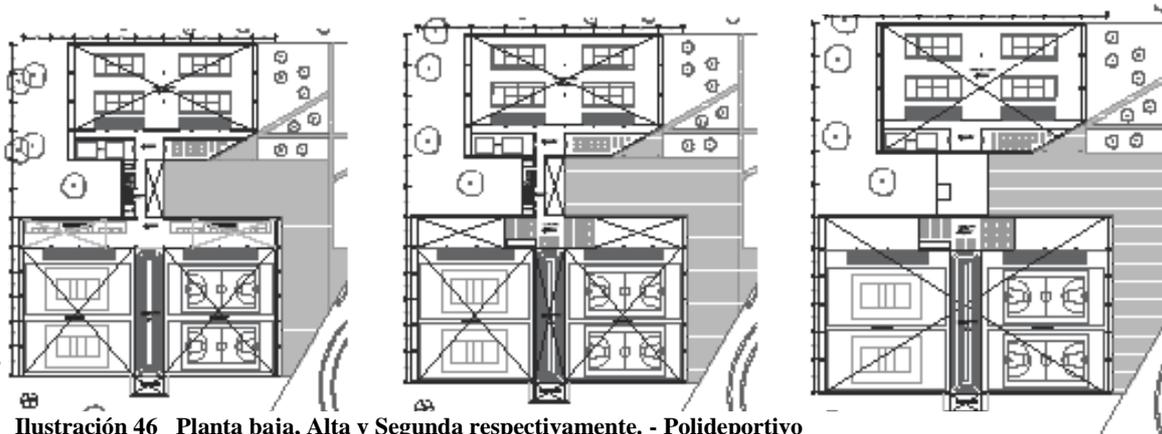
Planta baja, Alta y Segunda respectivamente. - Polideportivo
